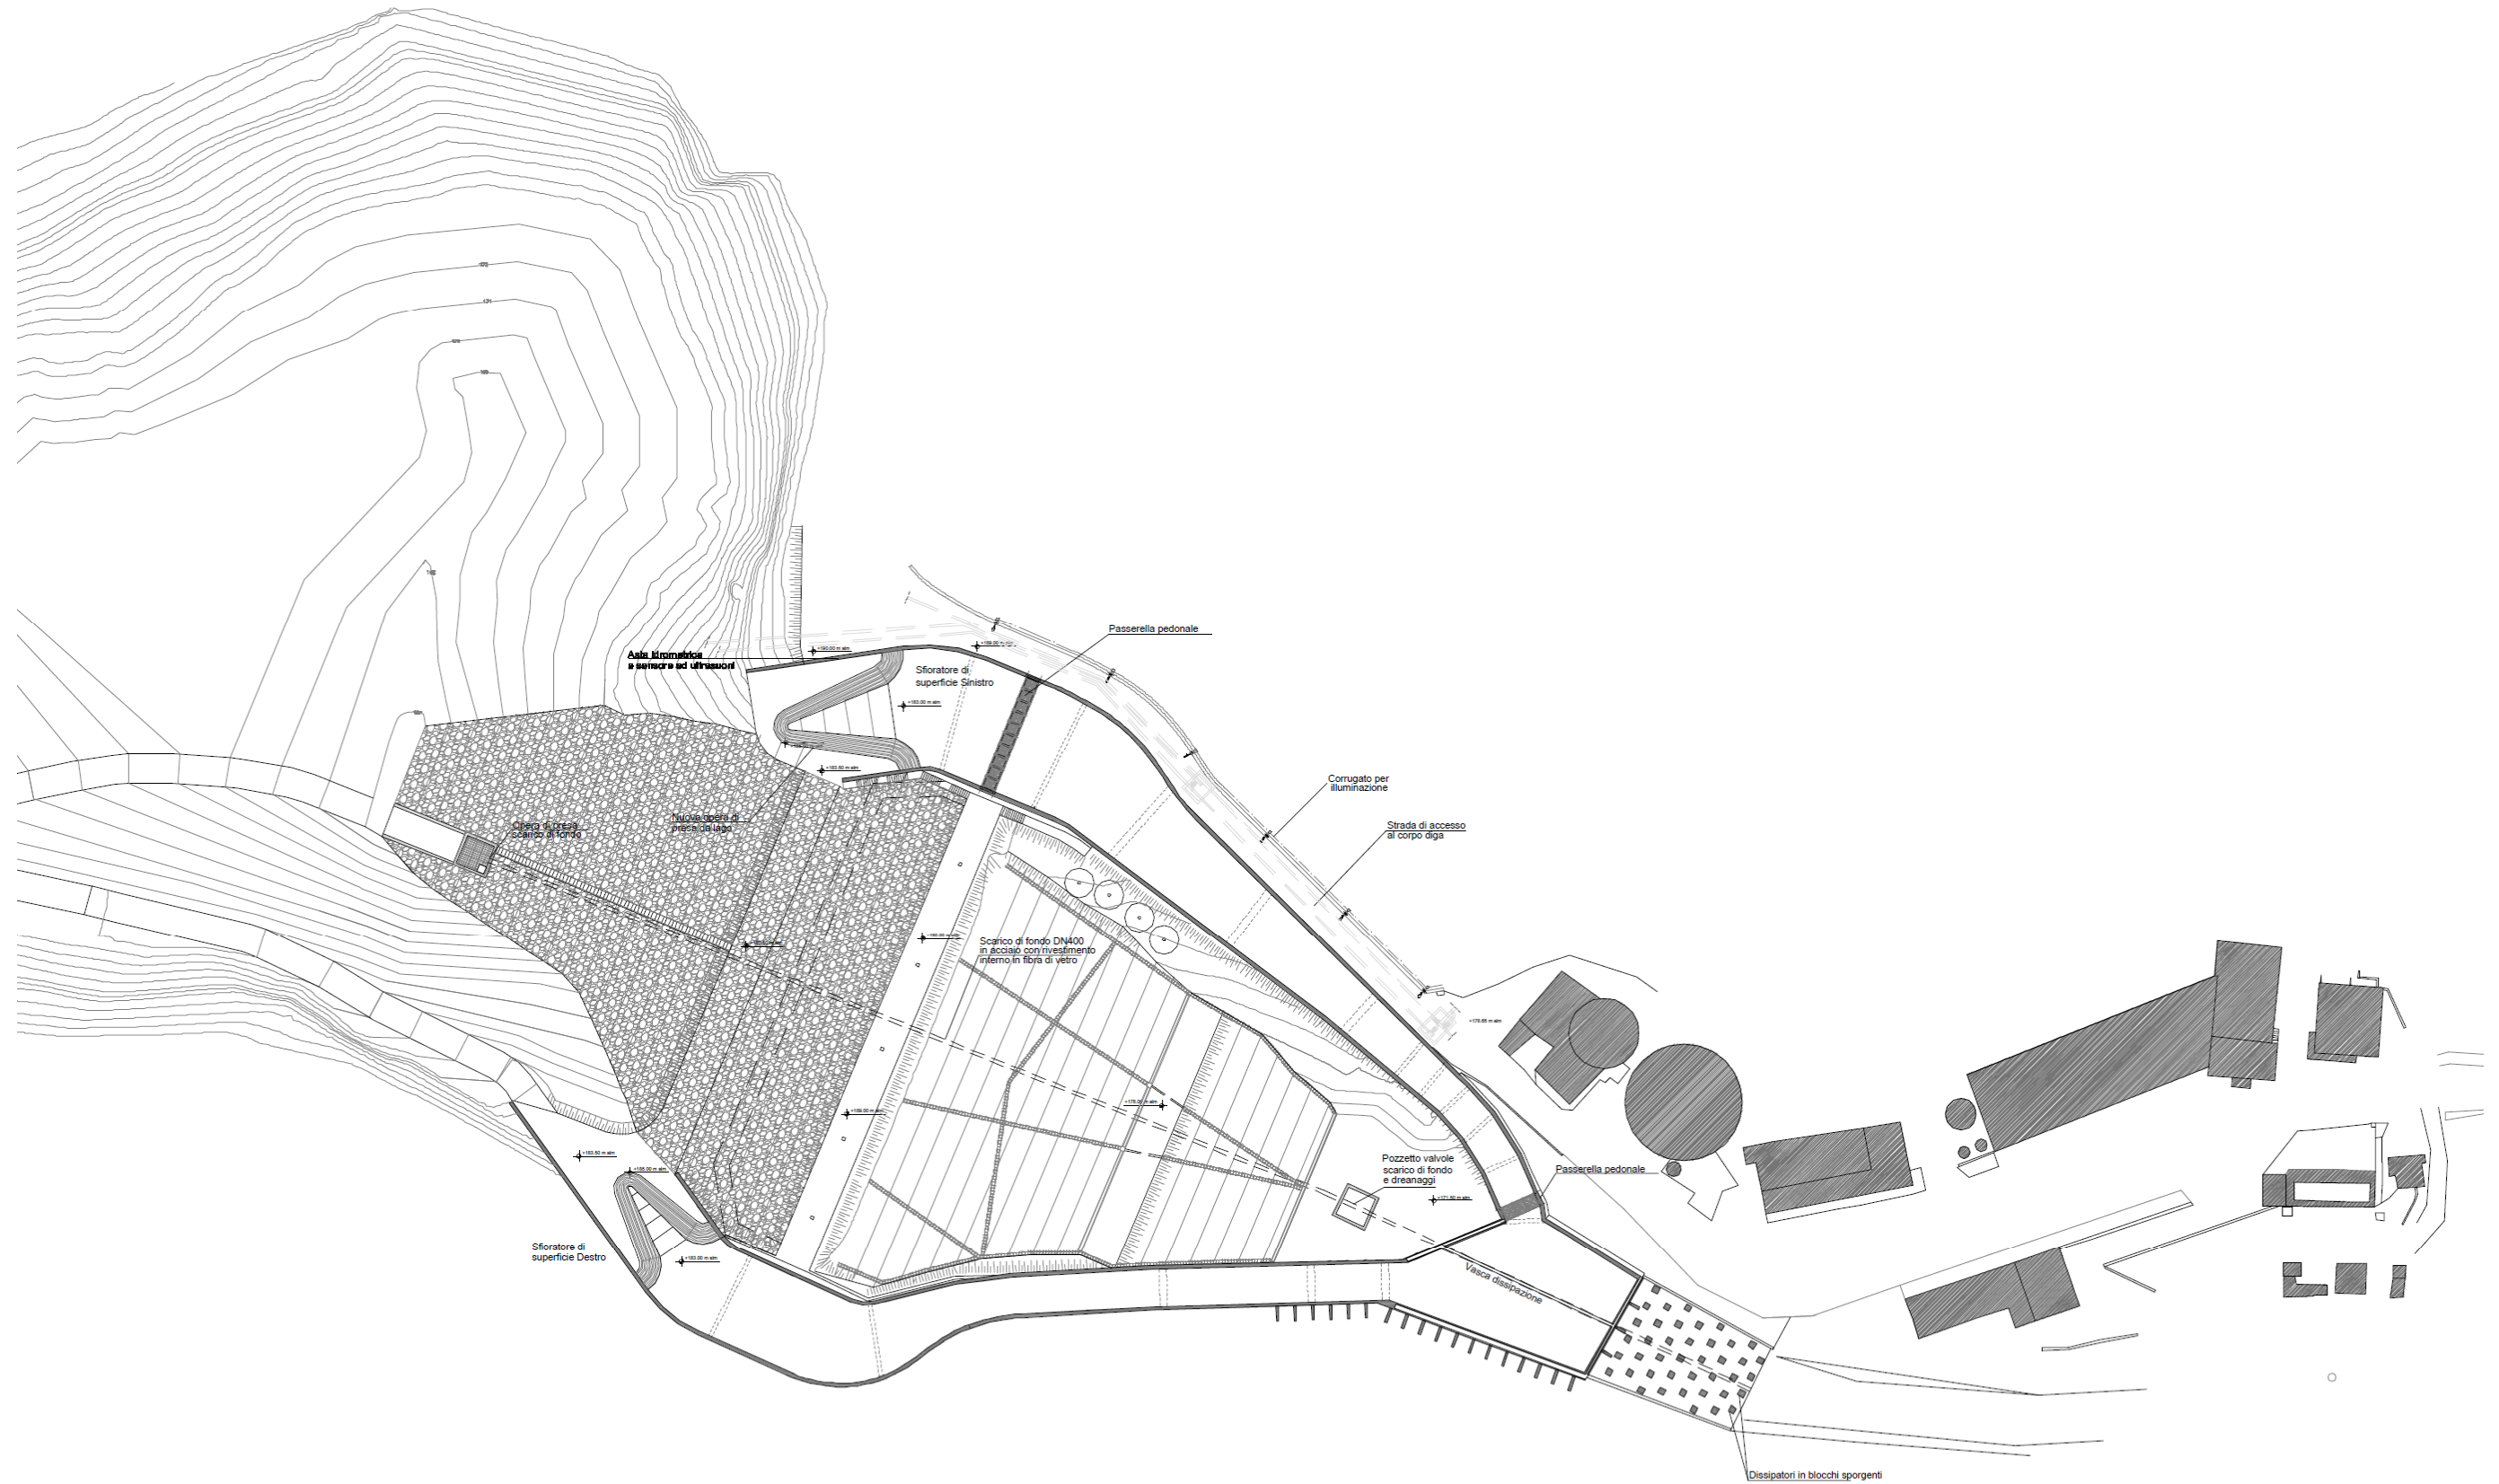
Planimetria della diga Drove di Cepparello nello stato di progetto.
